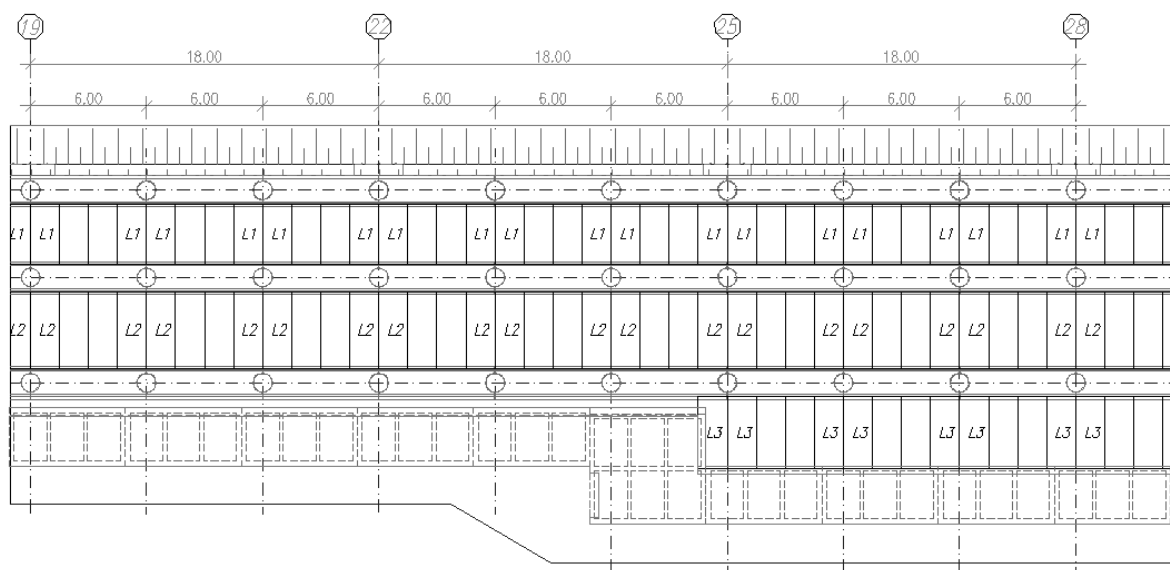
Planta do módulo estudado no modelo tridimensional.
